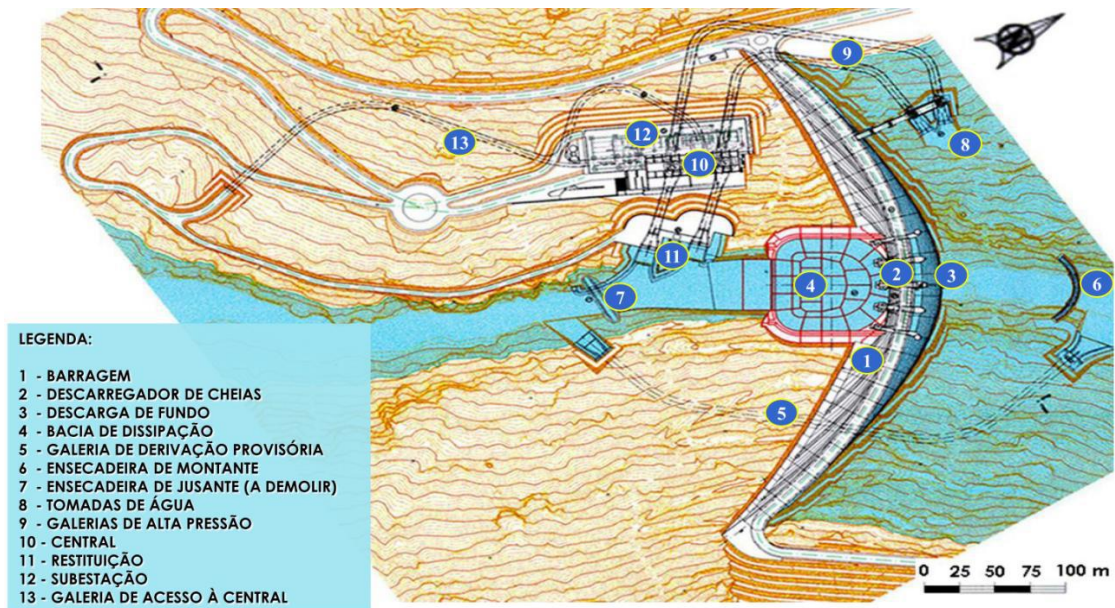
Planta geral das obras do escalão de montante do AHBS
